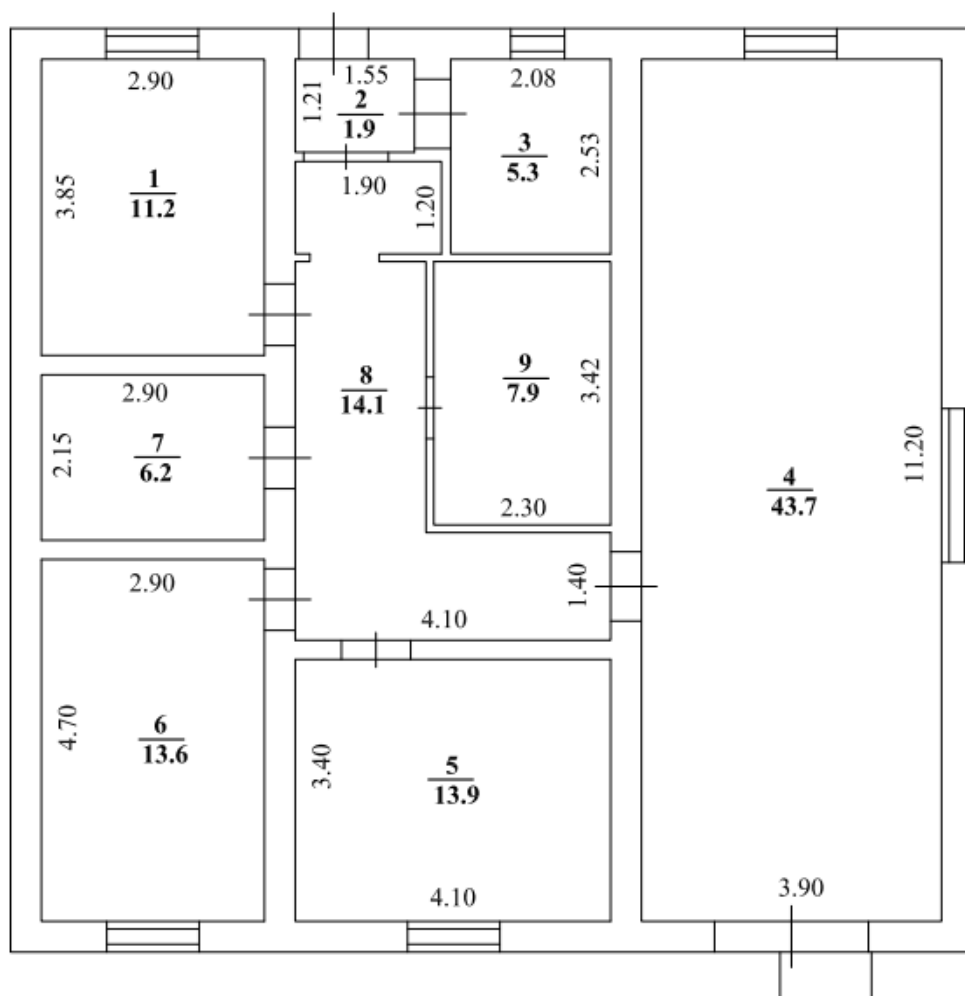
Поэтажный план здания – объекта кадастровых работ
